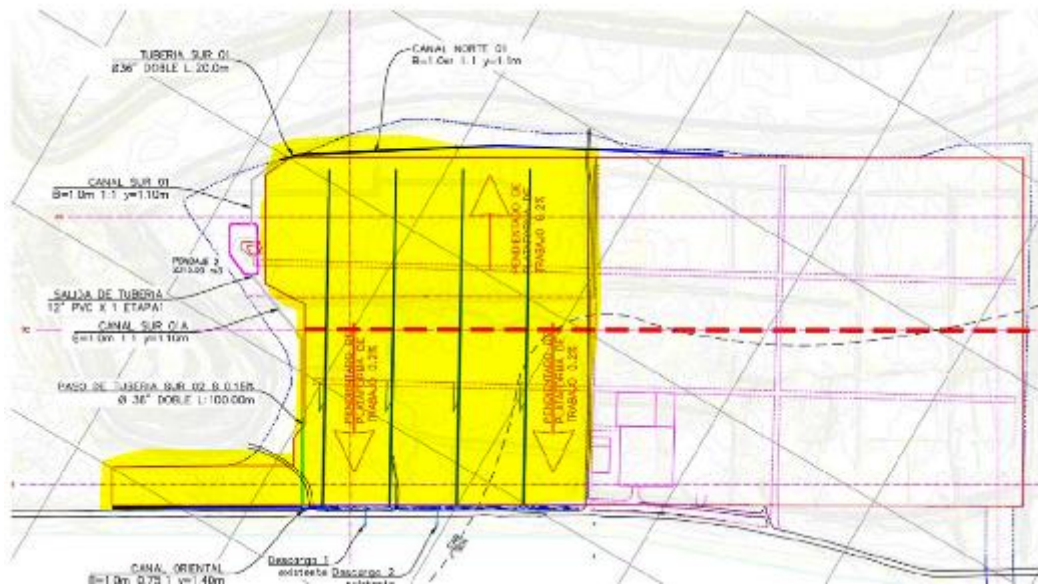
Localización de obras de drenaje en la plataforma en la etapa de construcción
